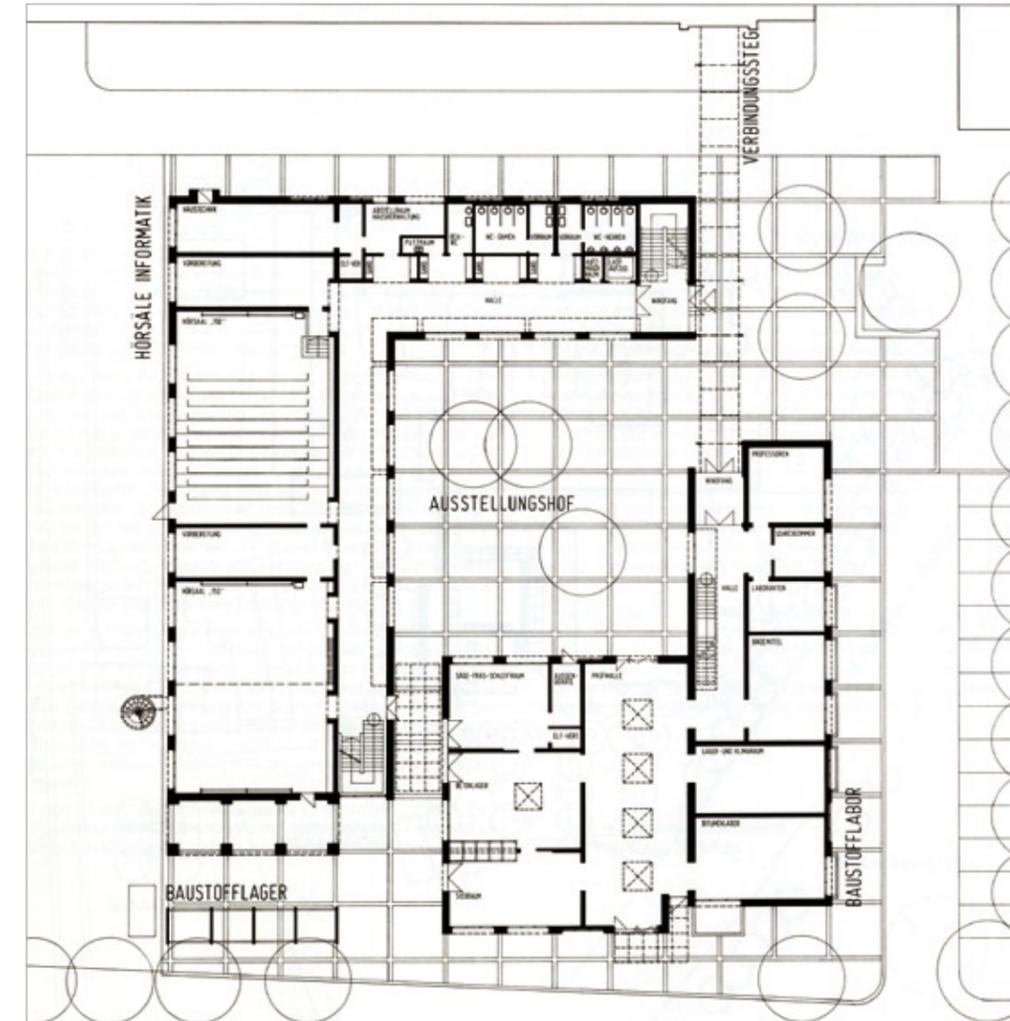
Hochschule Augsburg, Gebäude G, Grundriss Erdgeschoss
